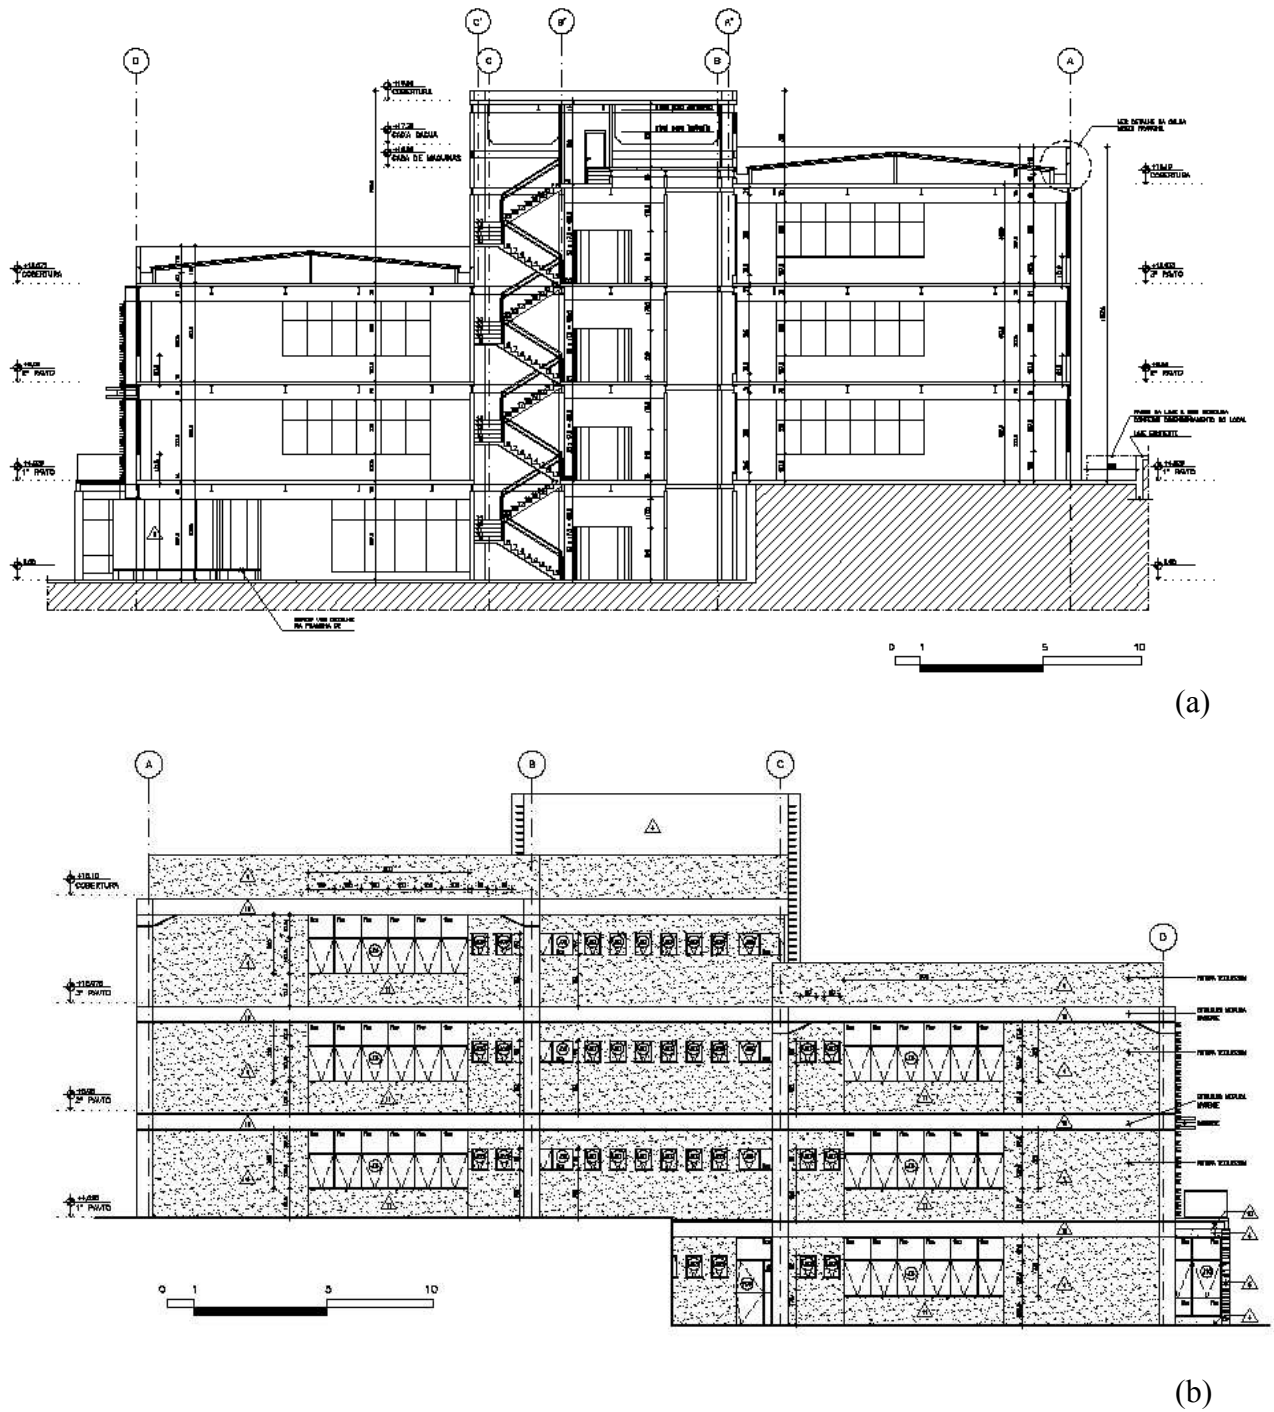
Projeto arquitetônico do empreendimento do estudo de caso. (a) corte AA e (b) fachada frontal (Fonte: arquivo EC-A)
